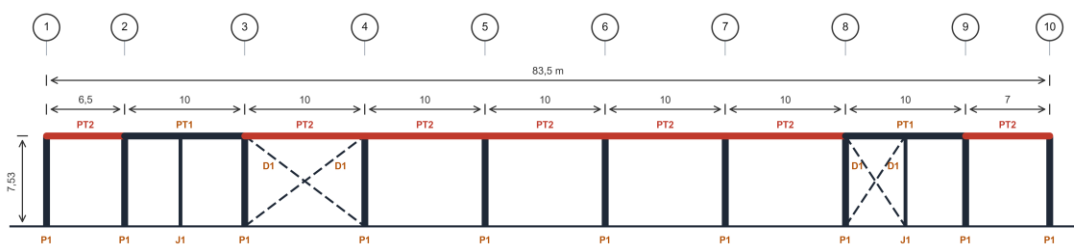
Elevación longitudinal ejes A y G construida: vigas PT2 en rojo (PT1 solo en ejes 2-3 y 8-9).
